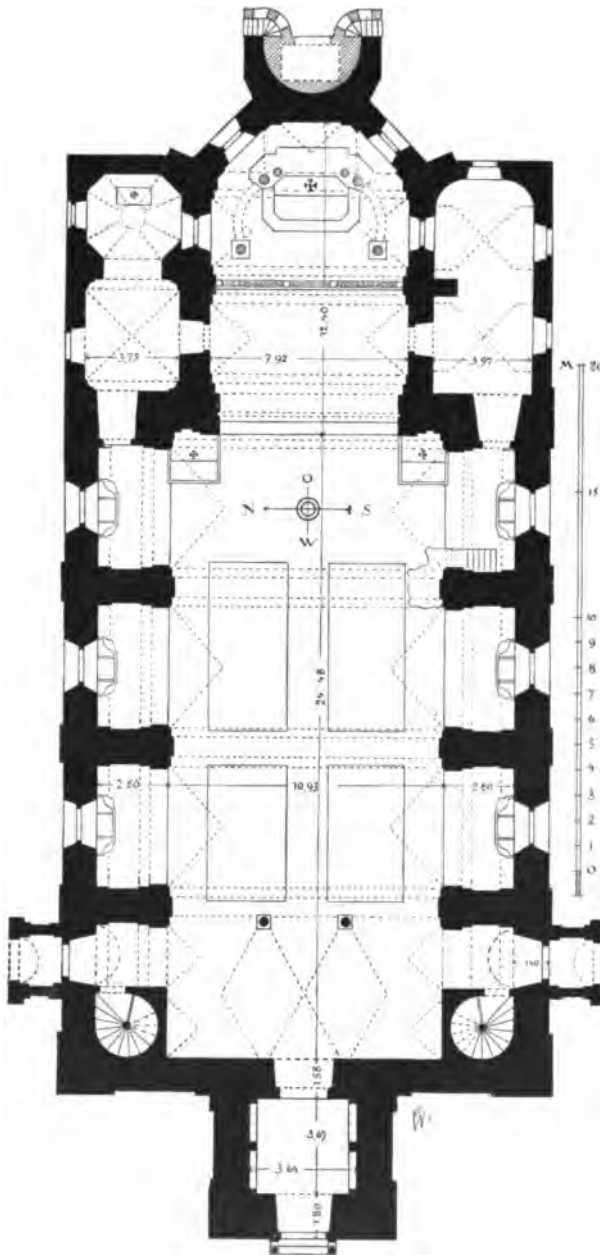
Eichelberg. Grundriß der Wallfahrtskirche.
